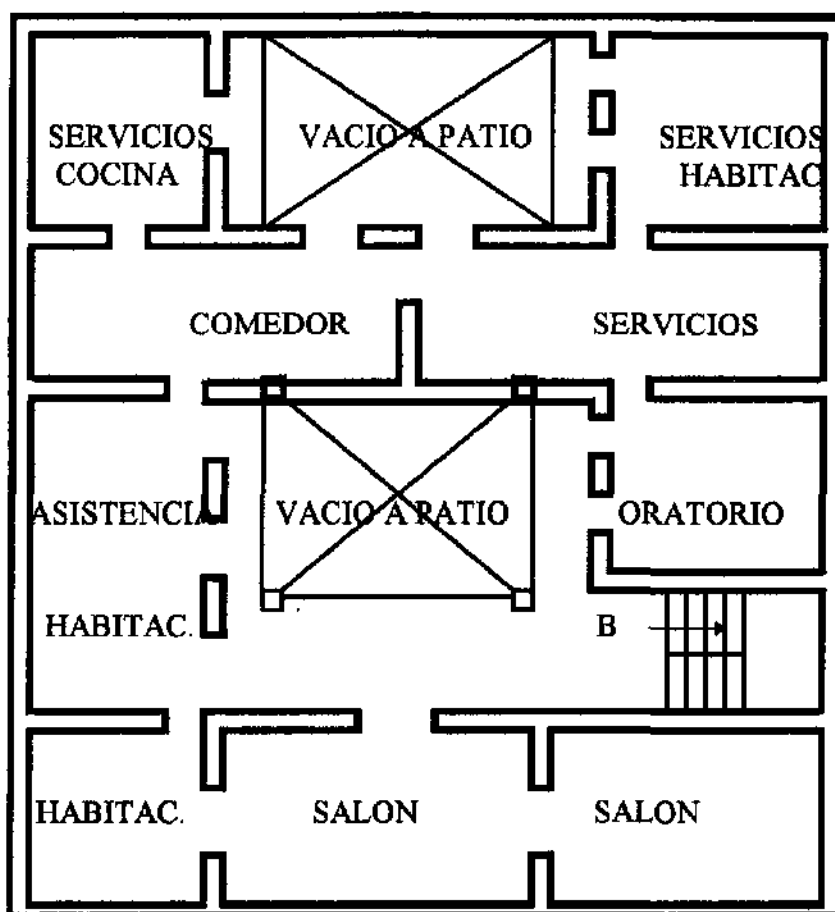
ESQUEMA ARQUITECTÓNICO Planta alta
